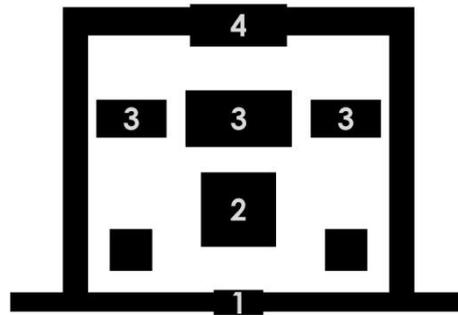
, Grundriss des Hwangnyongsa, Südkorea, 533 n. Chr.
